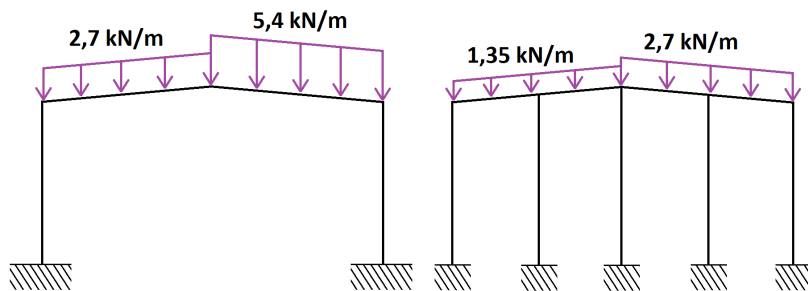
Cargas de nieve sobre los pórticos interiores y de fachada, caso 3
